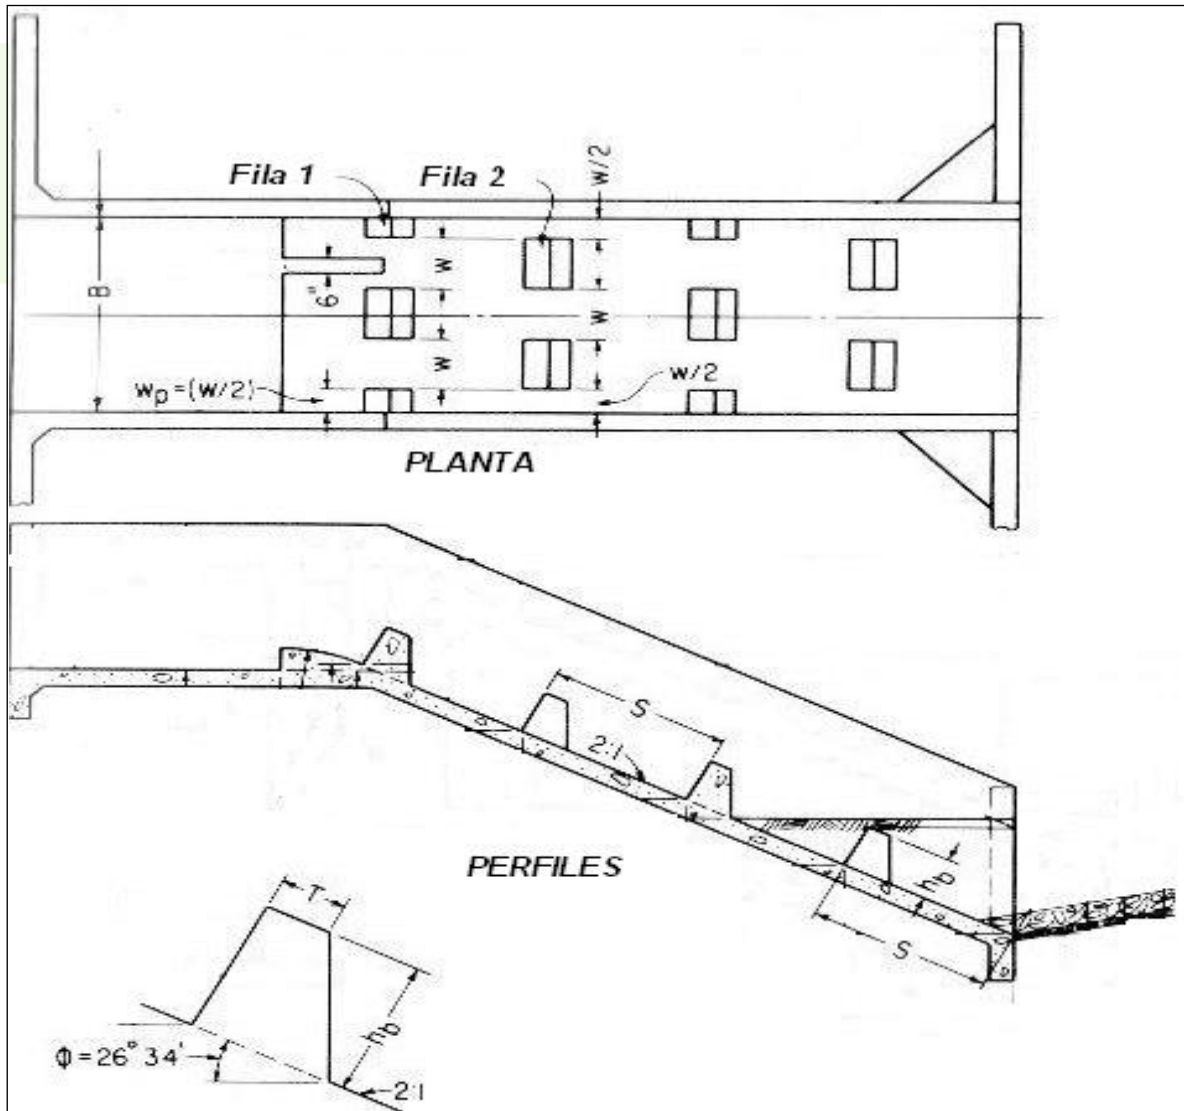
Esquema estructura de entrega con bloques¹⁹
